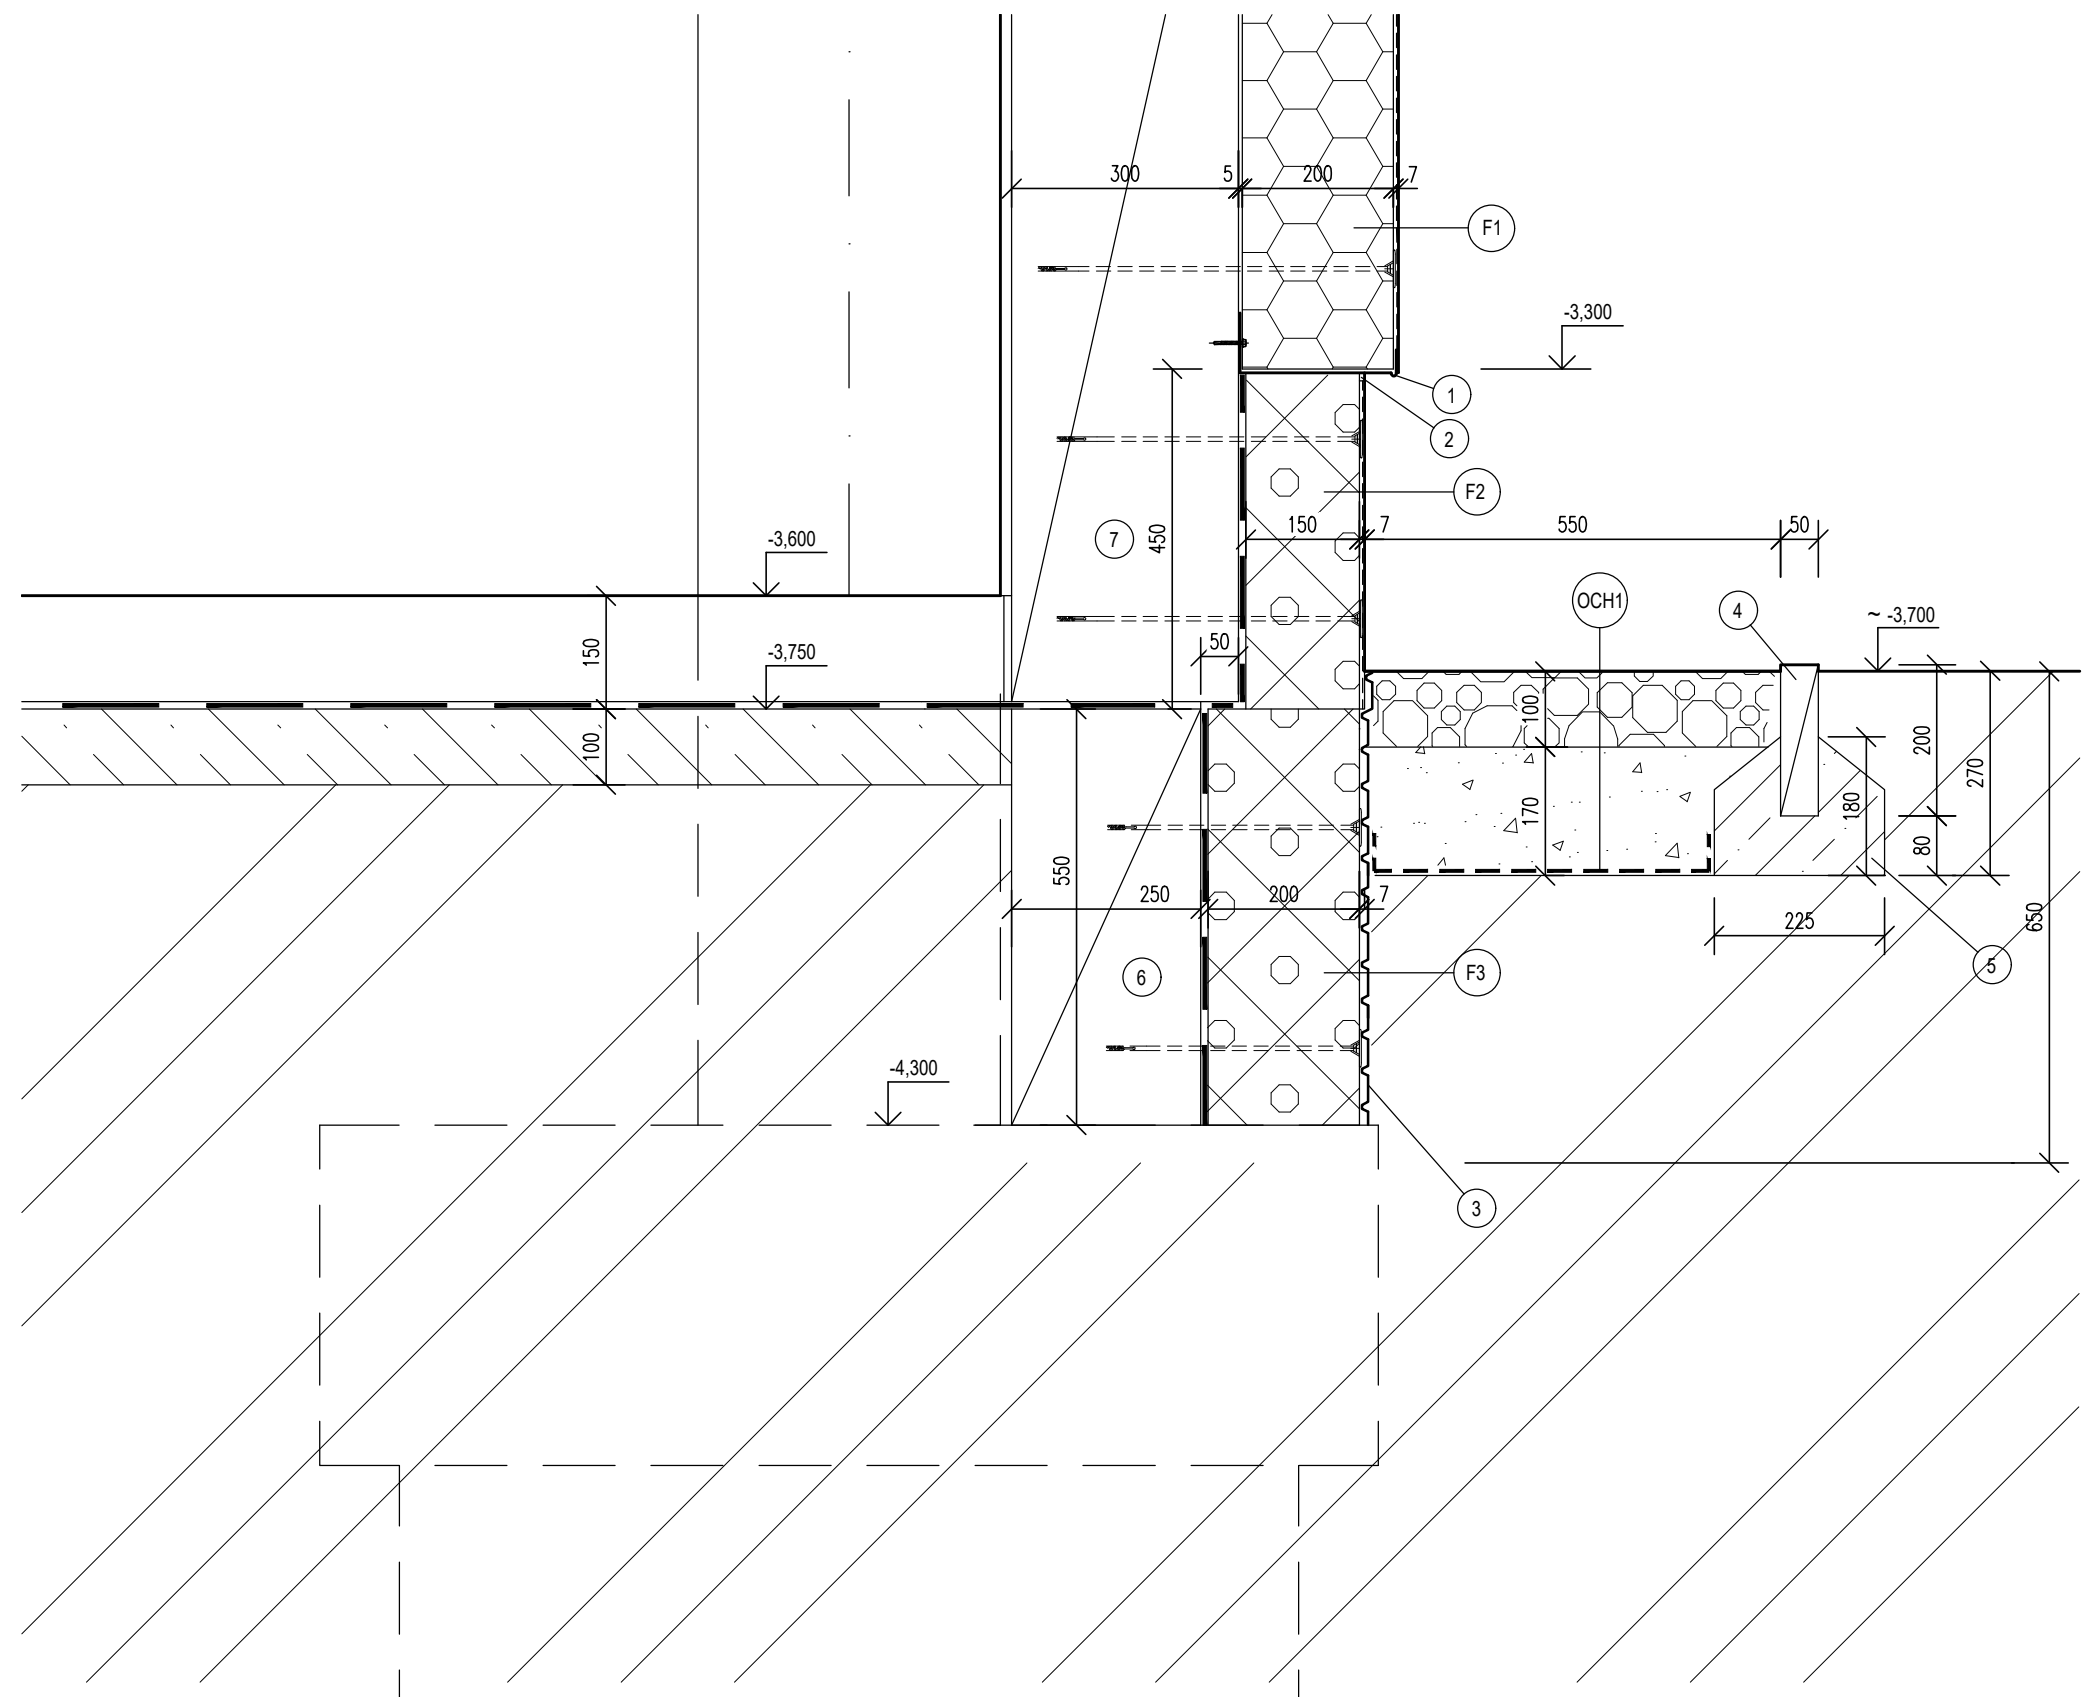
SOKEL PRI BETÓN. CHODNÍKU M 1:10
